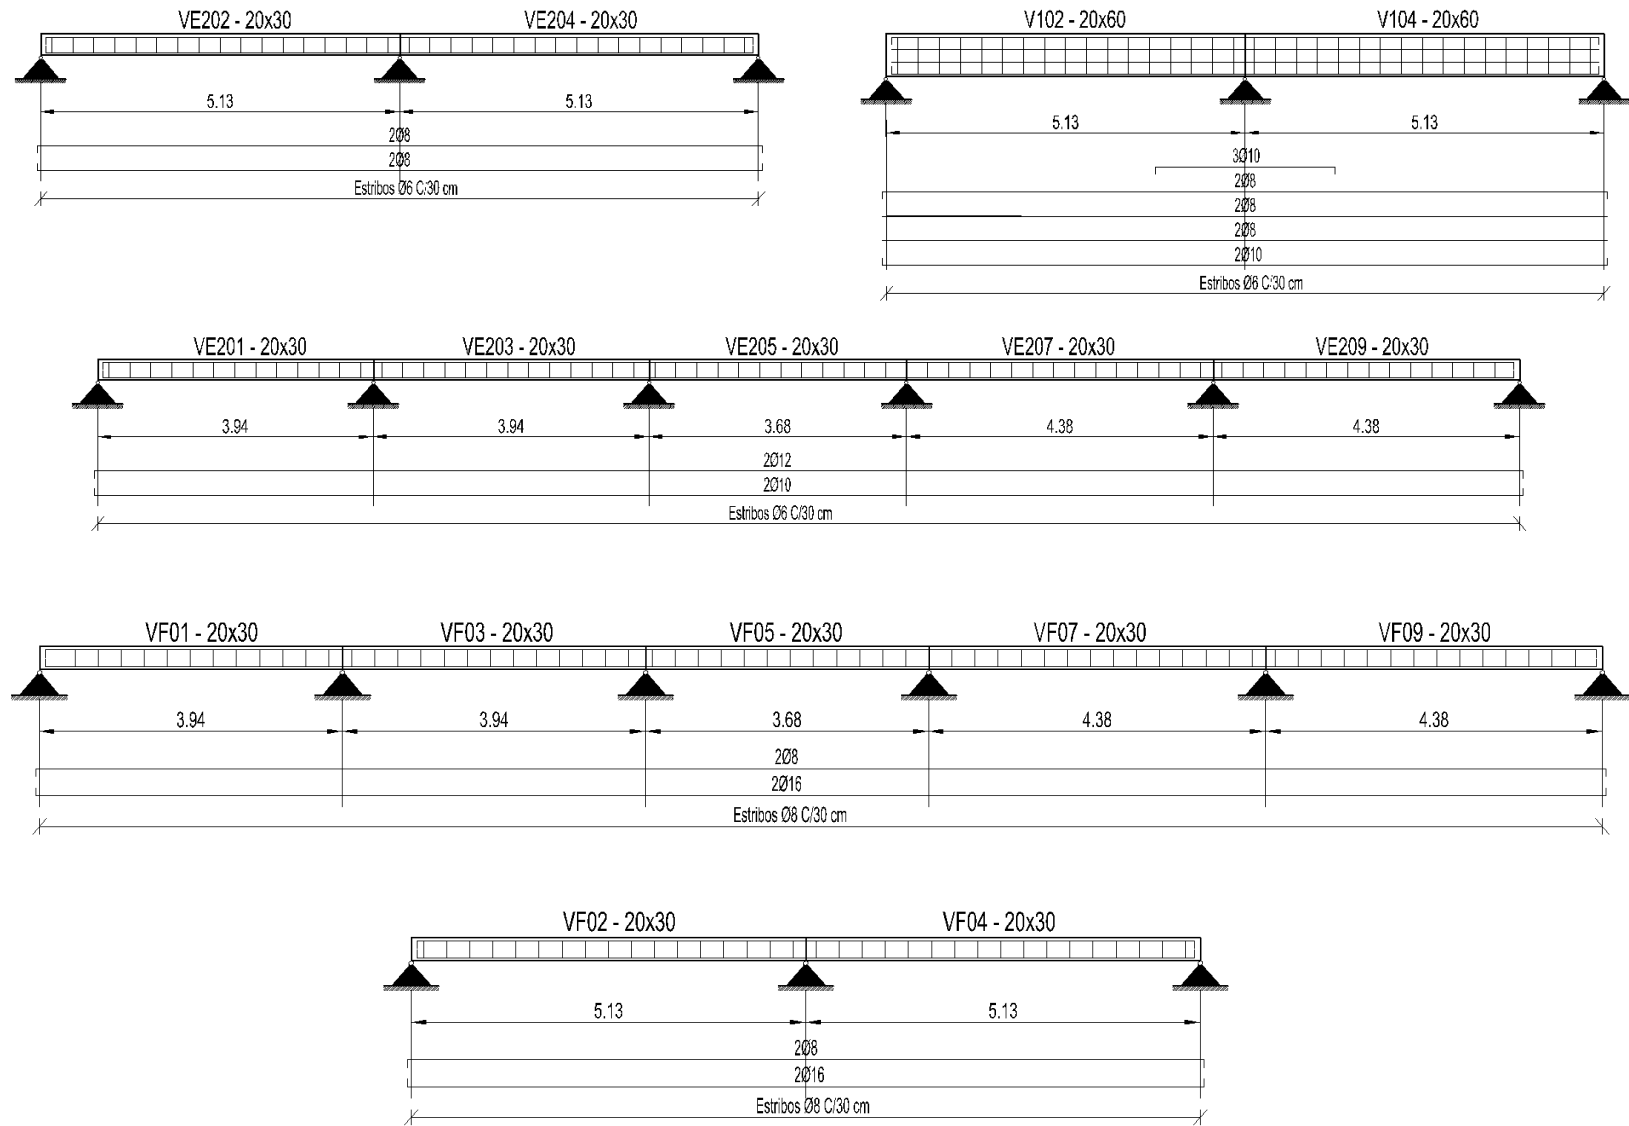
Armado de vigas sobre 2do Piso y Vigas de Fundación.
